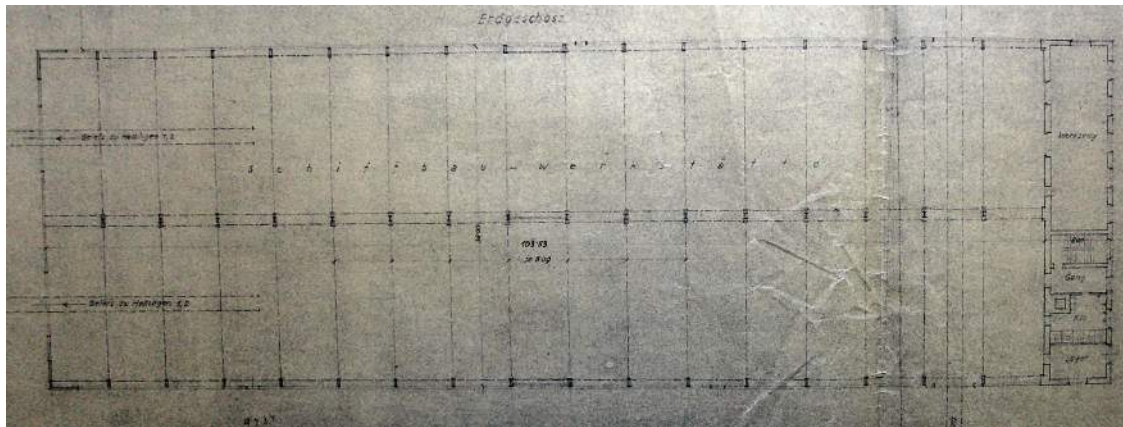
Grundrissdarstellung der neuen Halle mit nordwestseitigem Massivbau
